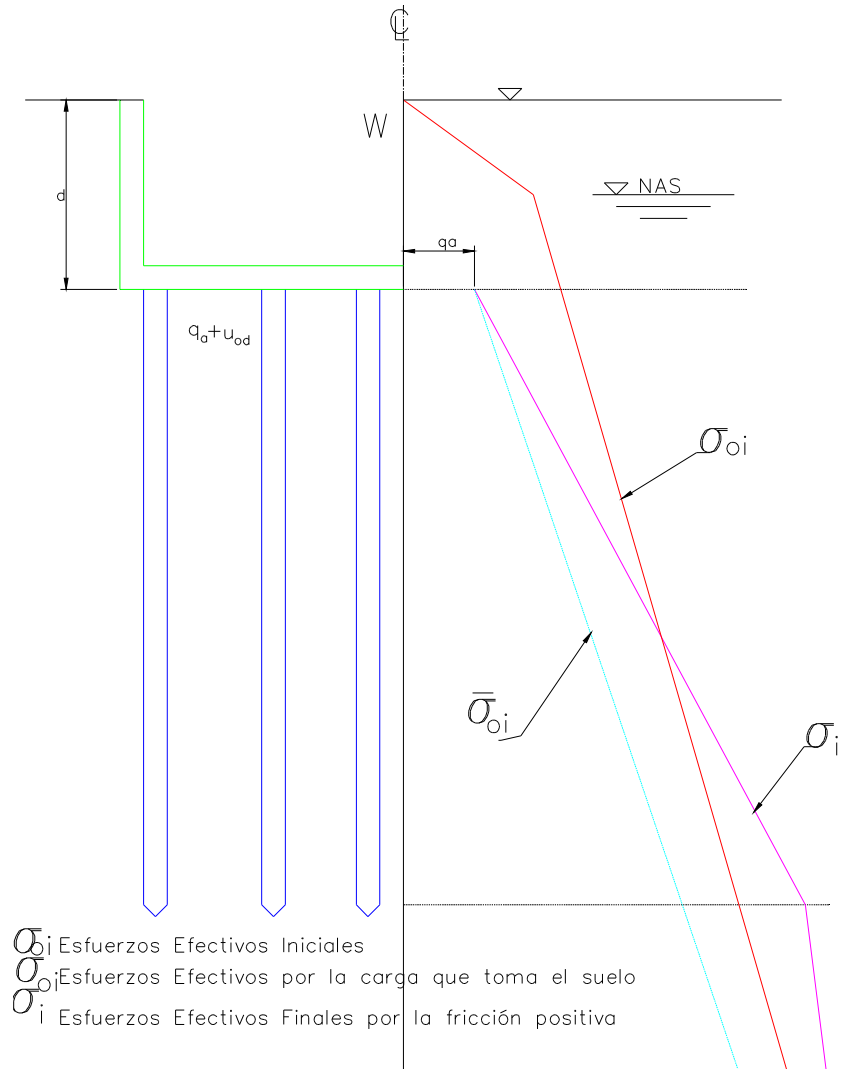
Esfuerzos efectivos con pilotes de fricción (López R., 2005)
